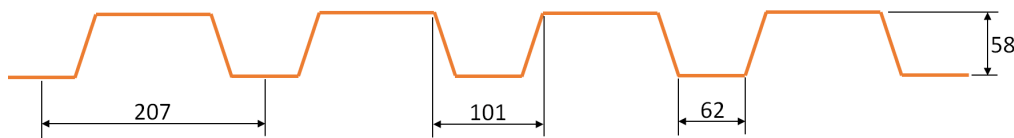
Dimensions d'un bac acier de type Cofraplus 60 (mm)
